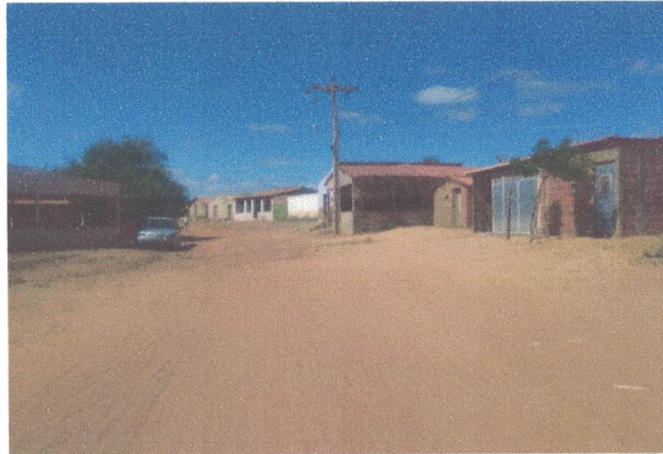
RUA PROJETADA - TRECHO 2
